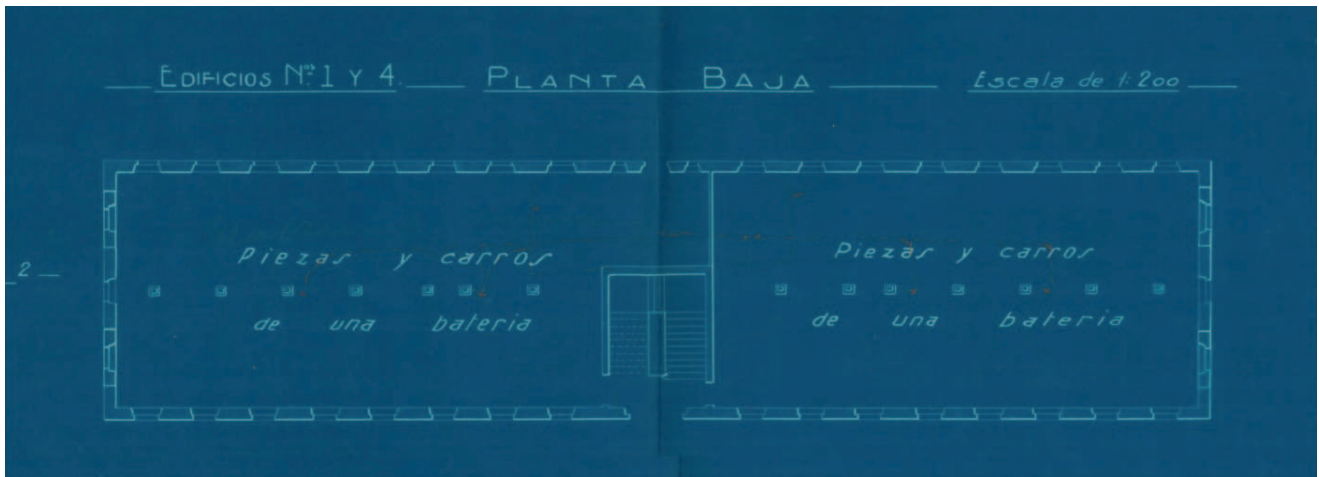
Planta de distribución original de la planta baja. Pabellón nº 4
